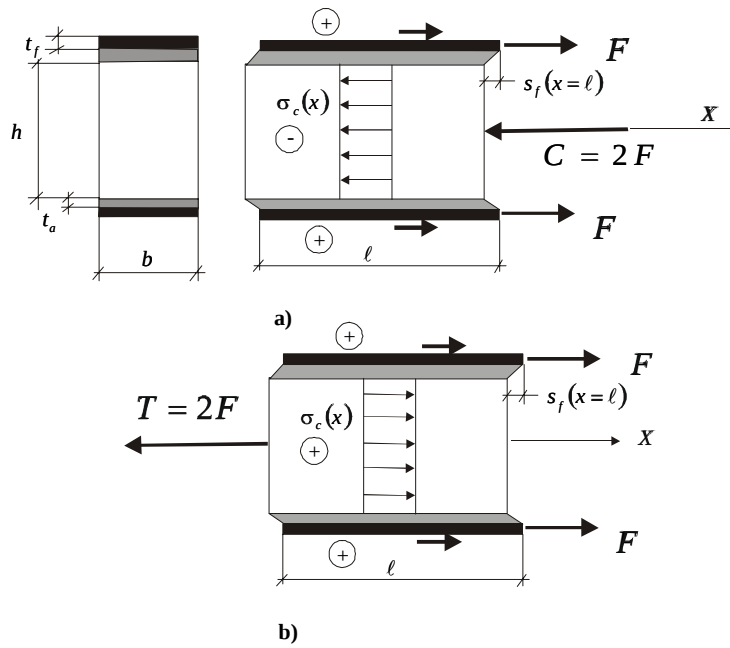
Ensaio de aderência CFC-concreto: a) ensaio T-C; b) ensaio T-T.
